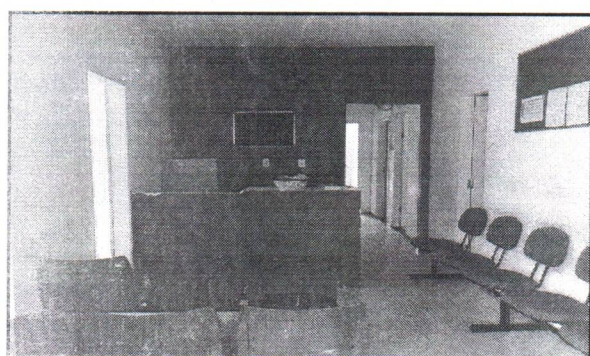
Imagem da área de Recepção, com piso cerâmico e forro em gesso
